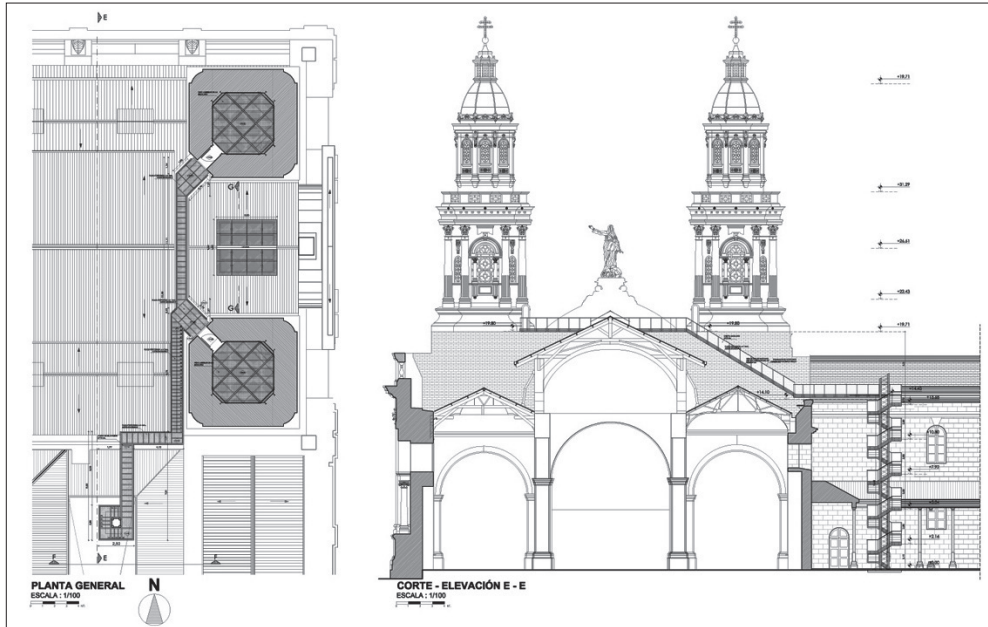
Il sistema di accesso alle coperture e alla torre, pianta e sezione (elaborazione dell'autore).
